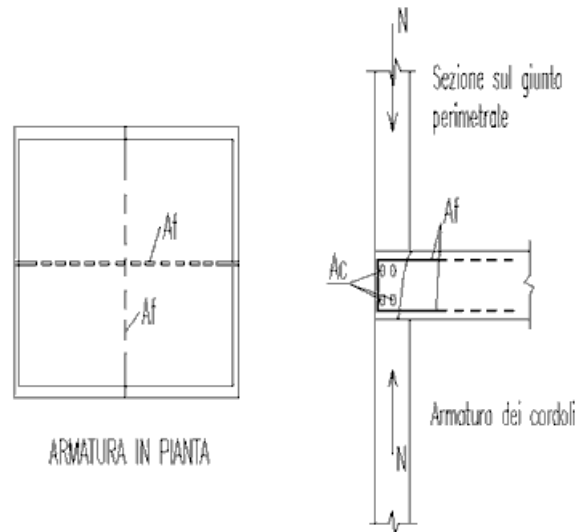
Armature minime di incatenamento e cordoli nei solai.
